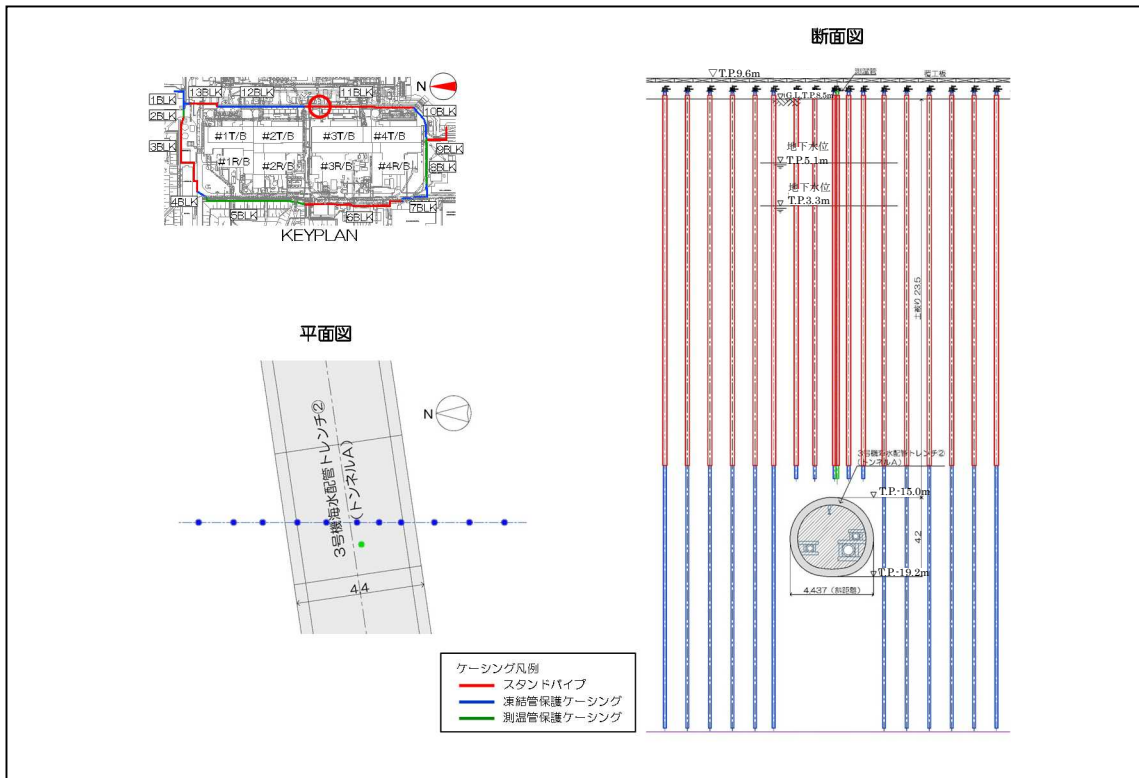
3号機海水配管トレンチトンネルA部 施工平面図・断面図
